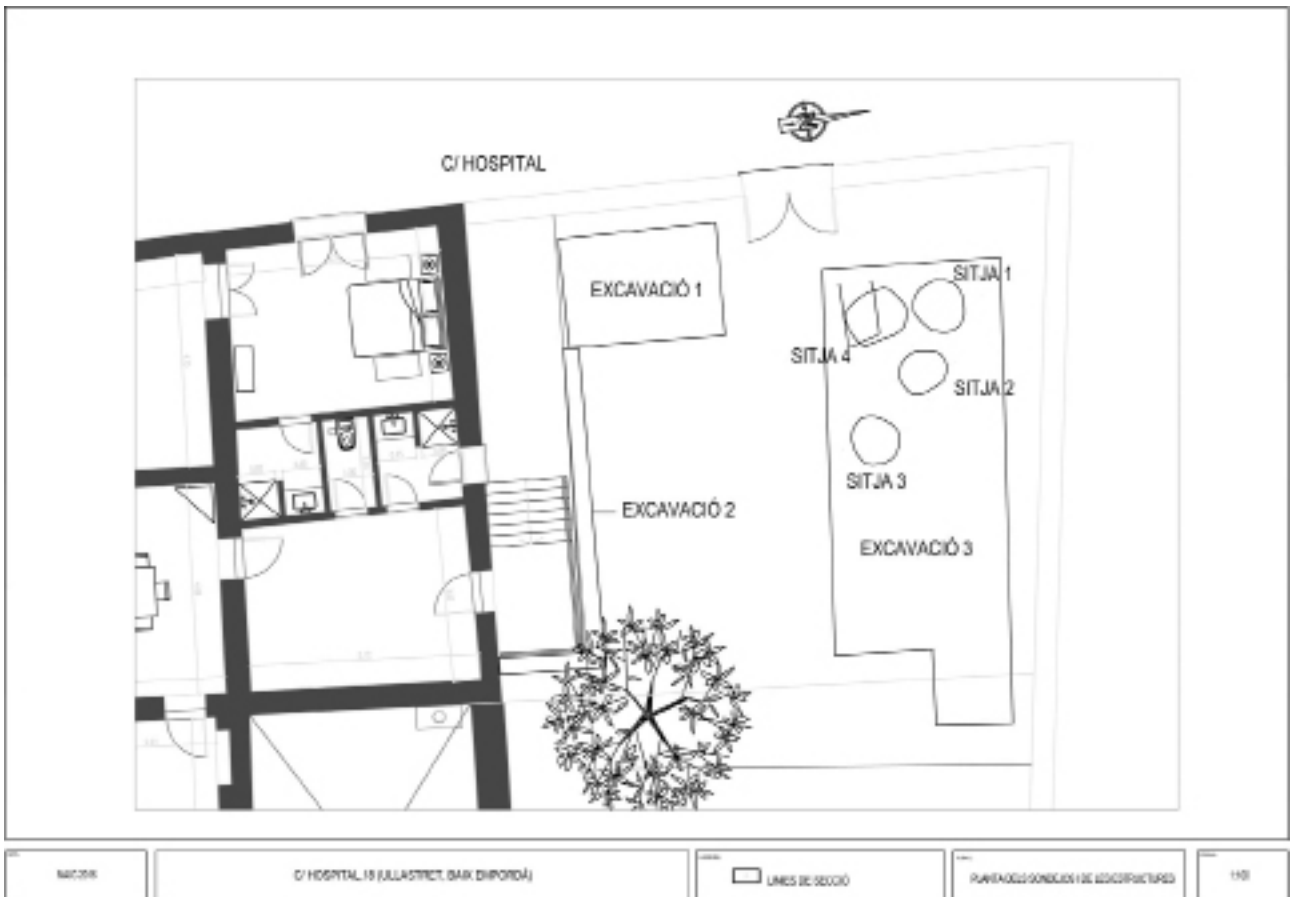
Planta de les estructures localitzades al C/ Hospital, 18.
